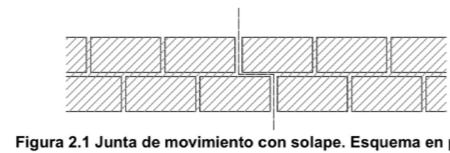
Junta de movimiento con solape. Esquema en planta
